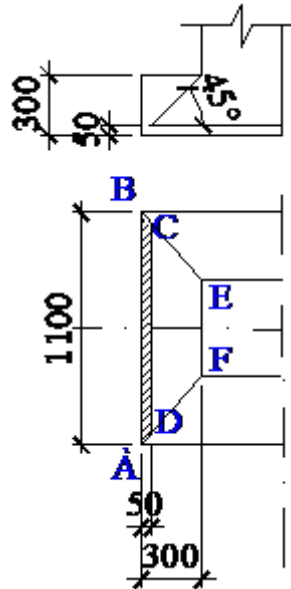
Розрахункова схема щодо визначення арматури підосви фундаменту
